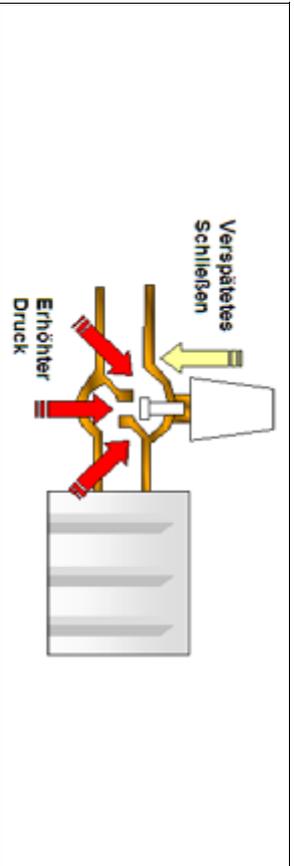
(N66) Ein zu hoher Druck des Heizwassers gegen das Thermostatventil kann zu verspätetem Schließen des Ventils führen.
